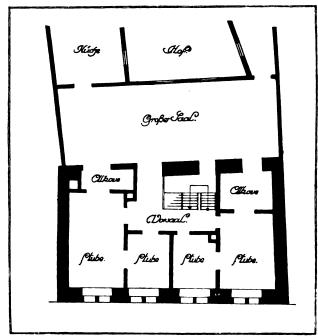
Obergeschoß von Poststraße 13 (Stadtbauamt).
